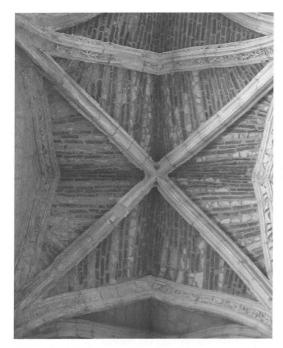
Bóveda con plementería de ladrillo y canto rodado, antes de la restauración (foto de Eduardo Barceló 2007)
